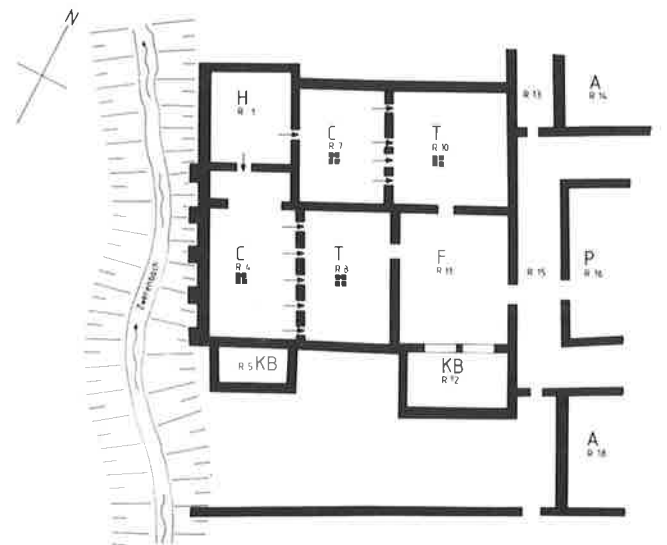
Bauphase 3; schematischer Grundriss
